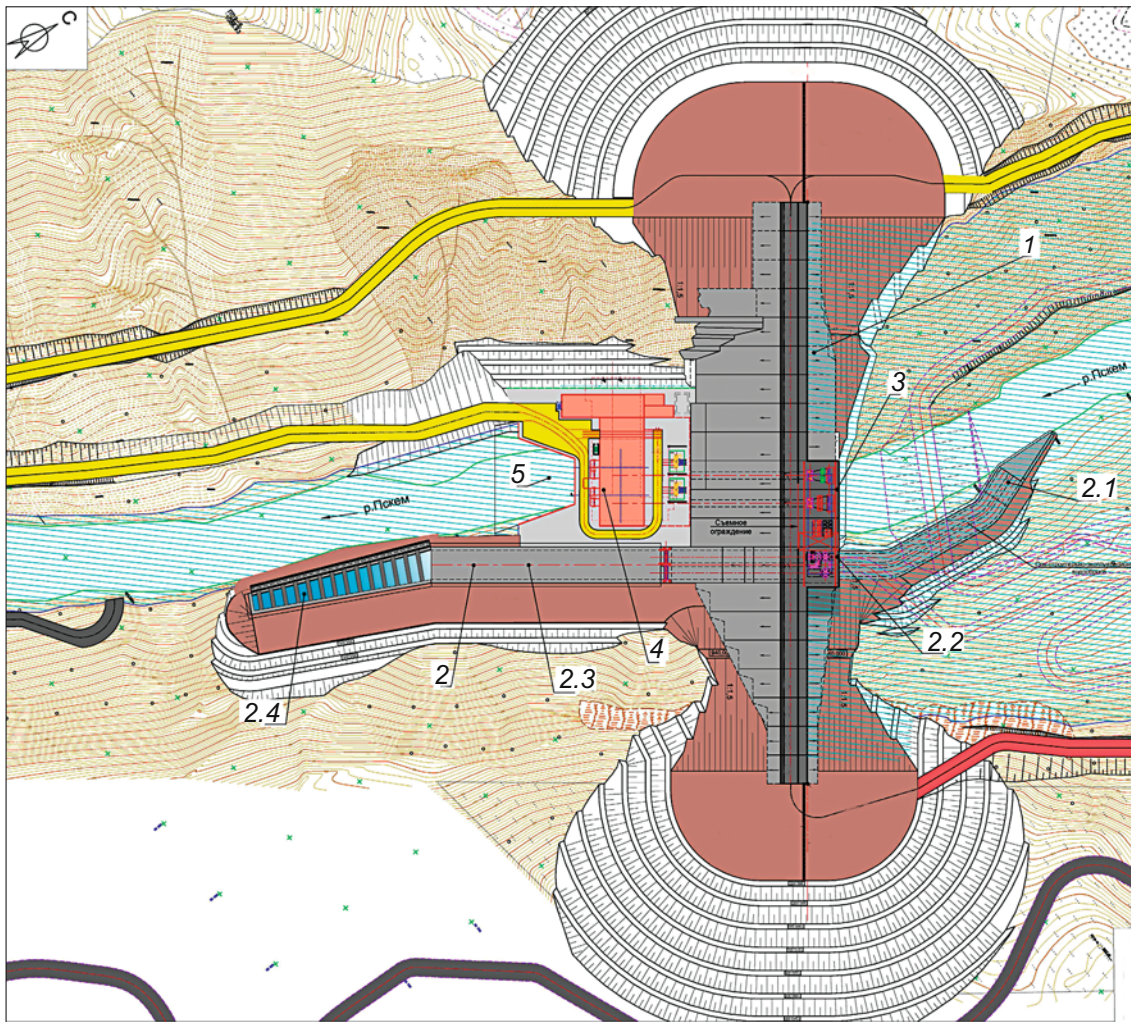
Бетонная плотина. План: 1 — бетонная гравитационная плотина; 2 — строительно-эксплуатационный водосброс (СЭВ); 2.1 — входной оголовок; 2.2 — водоприёмник СЭВ; 2.3 — водобойный колодец; 2.4 — боковой водослив; 3 — водоприёмник ГЭС; 4 — здание ГЭС; 5 — отводящий канал
